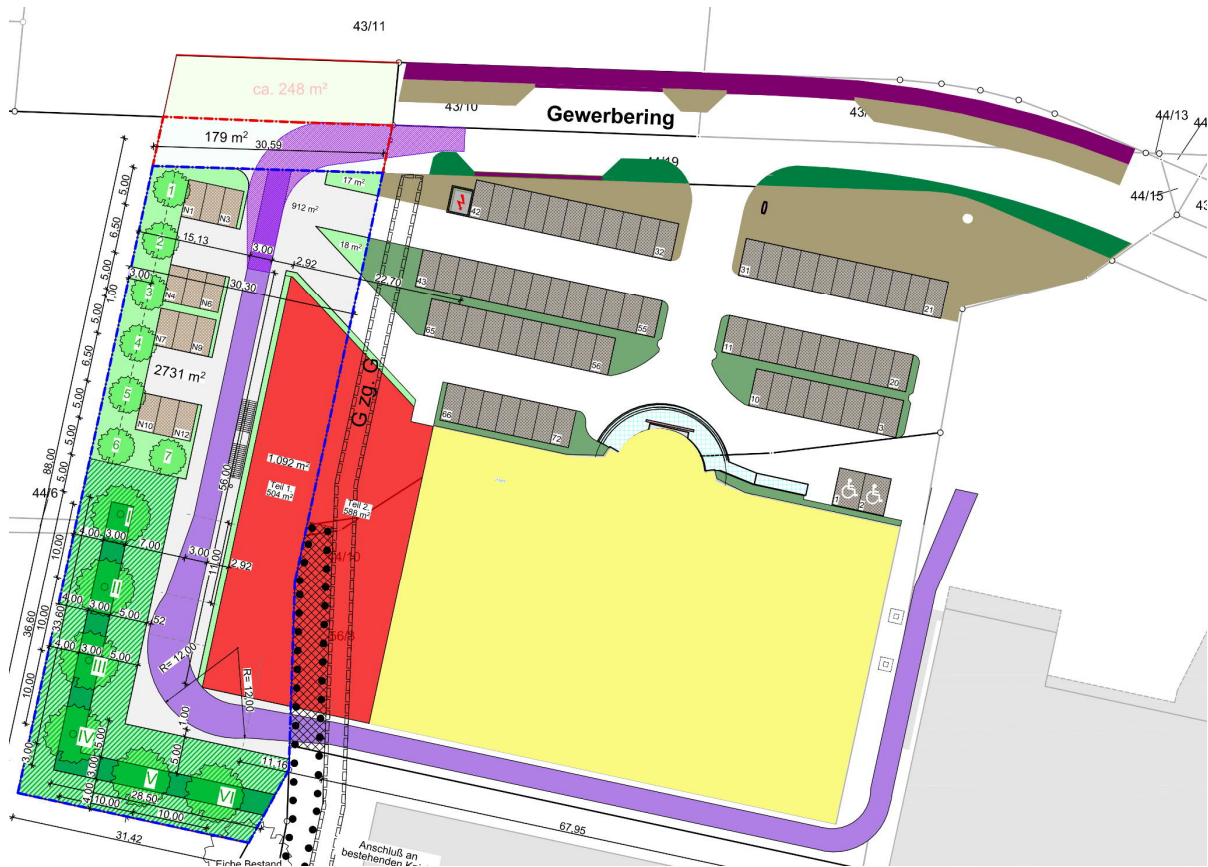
Lageplan Außenanlagen mit Erweiterung in rot
